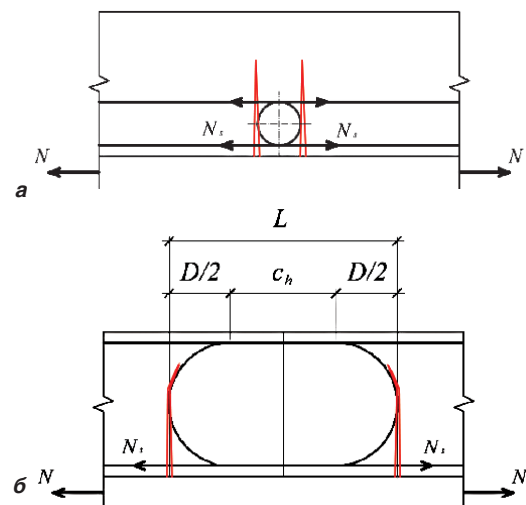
Схемы передачи усилий и положения магистральных трещин в линейных петлевых стыках: а – тип Л-1 – петлевой стык с двумя рядами арматуры у растянутой грани; б – тип Л-2 – петлевой стык-перепуск с одним рядом арматурных сеток у растянутой и сжатой грани
